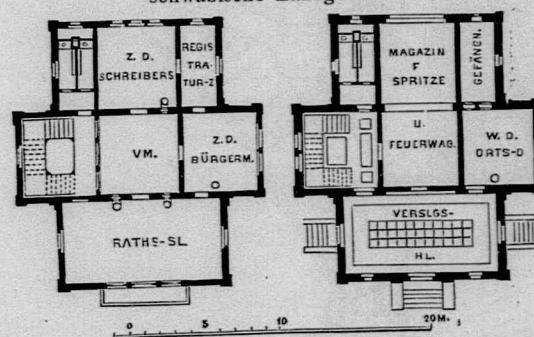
u. 266. Grundrisse des Rathauses zu Rastenburg.
